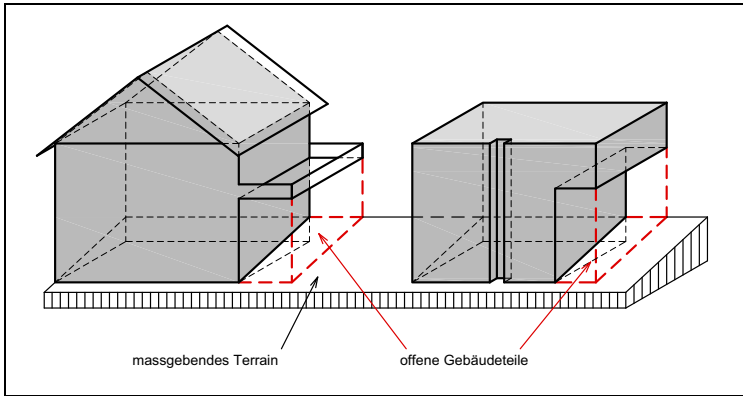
Anrechenbare Grundstücksfläche (§ 259 PBG)
